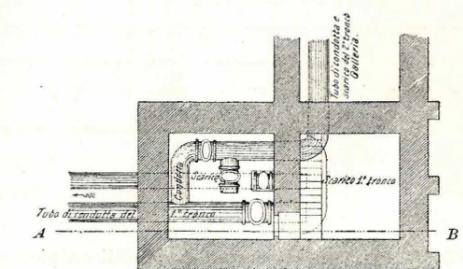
Pianta lungo la M-N-O-P (Scala 1:200).
